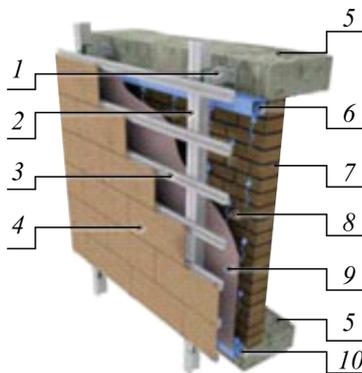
Навесная фасадная система с активным энергосбережением (общий вид с двумя теплоотражающими экранами) [7]: 1 – кронштейны фасада фасадной системы; 2 – вертикальный направляющие каркаса фасадной системы; 3 – горизонтальный профили; 4 – облицовка; 5 – плита перекрытия; 6 – канал сбора воздуха; 7 – несущая стена; 8 – активный поток воздуха; 9 – воздухо- непроницаемый экран; 10 – распределительный канал потока воздуха
